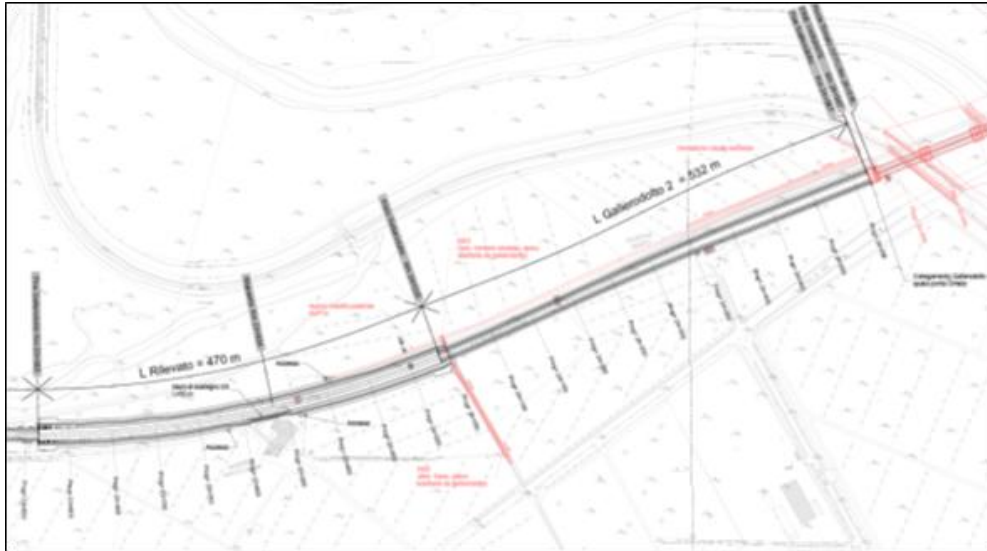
Planimetria di progetto nel tratto in rilevato a cavallo della masseria e nel 2° tratto di gallerodotto
